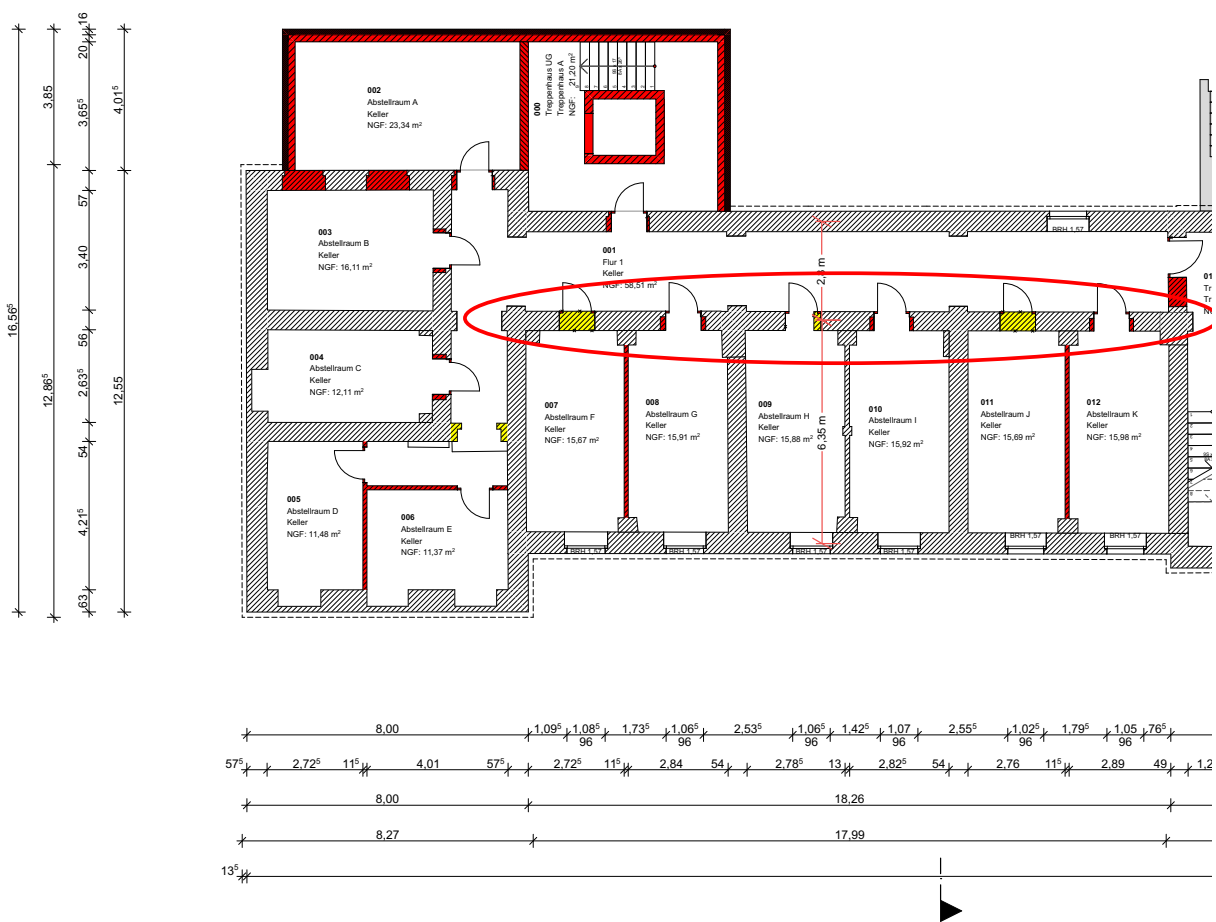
Kellergrundriss mit der nachzuweisenden Innenwand
